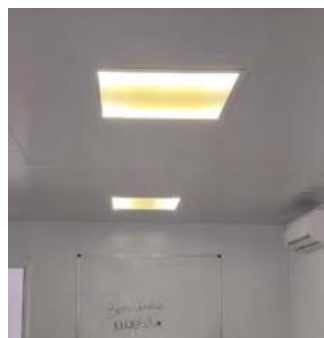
Plafons de embutir 60x60 danificados no CIGERD de Blumenau.
